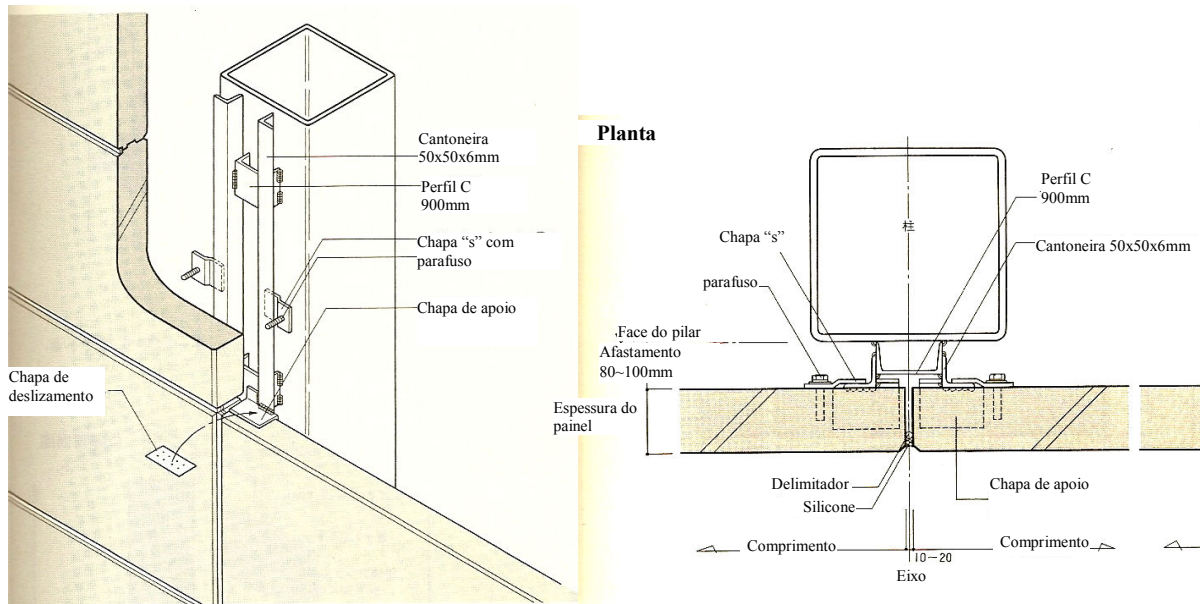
Ligação de painéis horizontais com encaixe das ligações de contraventamento (adaptado de CLION, 2001)
